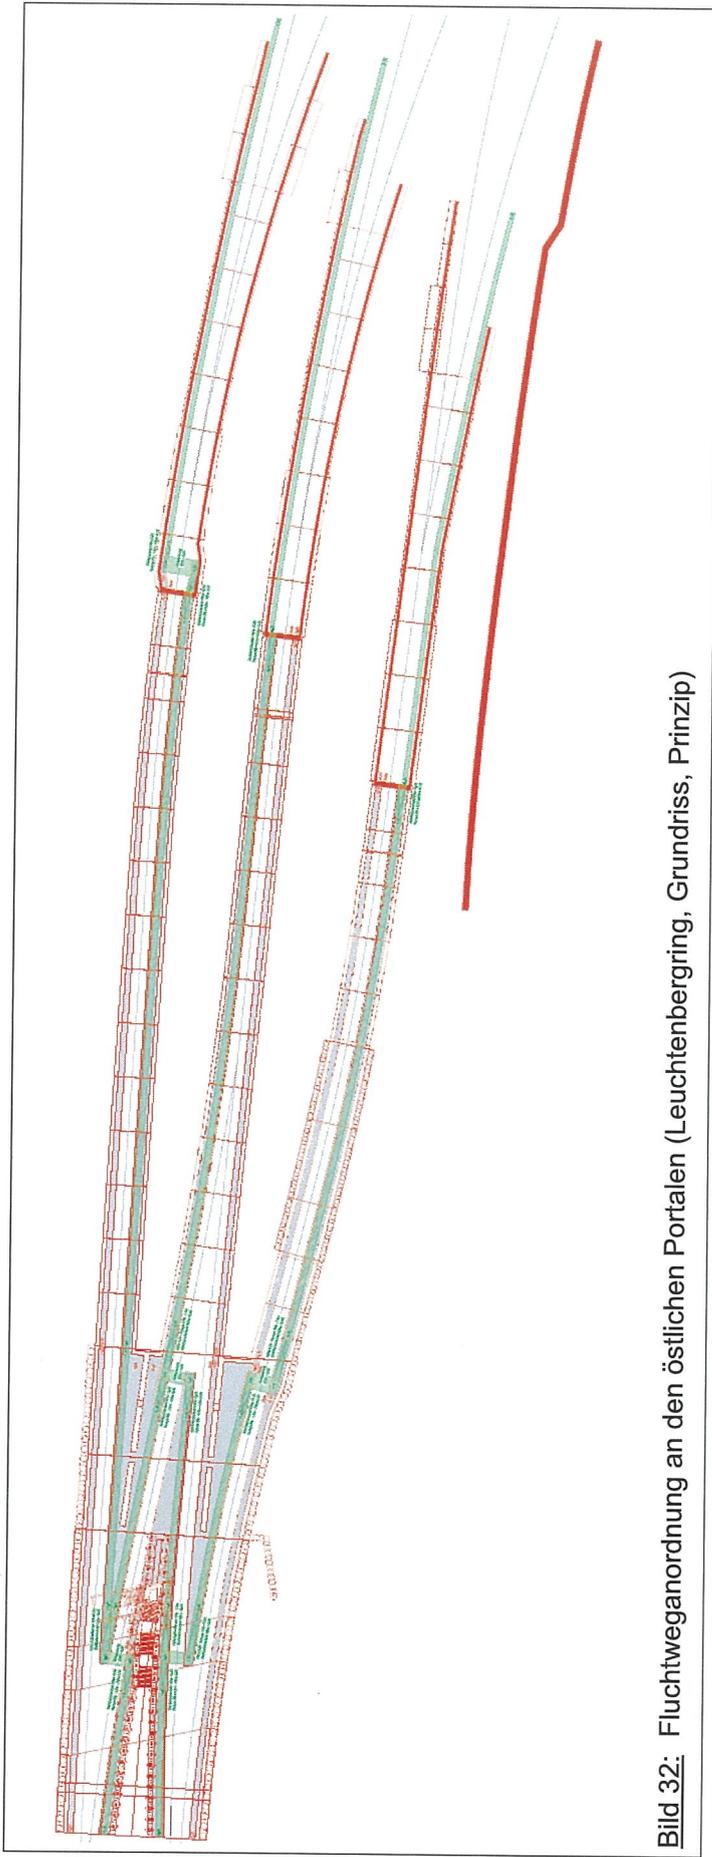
Fluchtwegordnung an den östlichen Portalen (Leuchtenbergiring, Grundriss, Prinzip)
